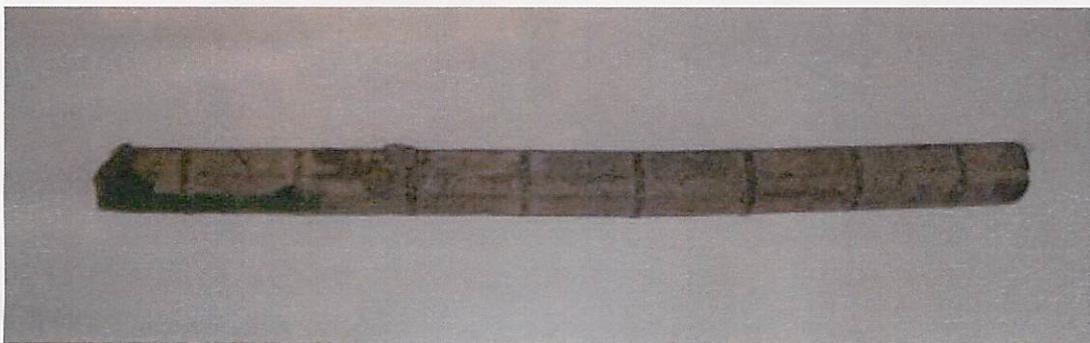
大正時代の異形鉄筋(直径約19mm)
